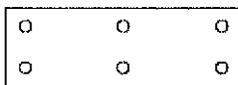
Plan de chevillage - panneaux de dimensions 1200 x 400 mm
